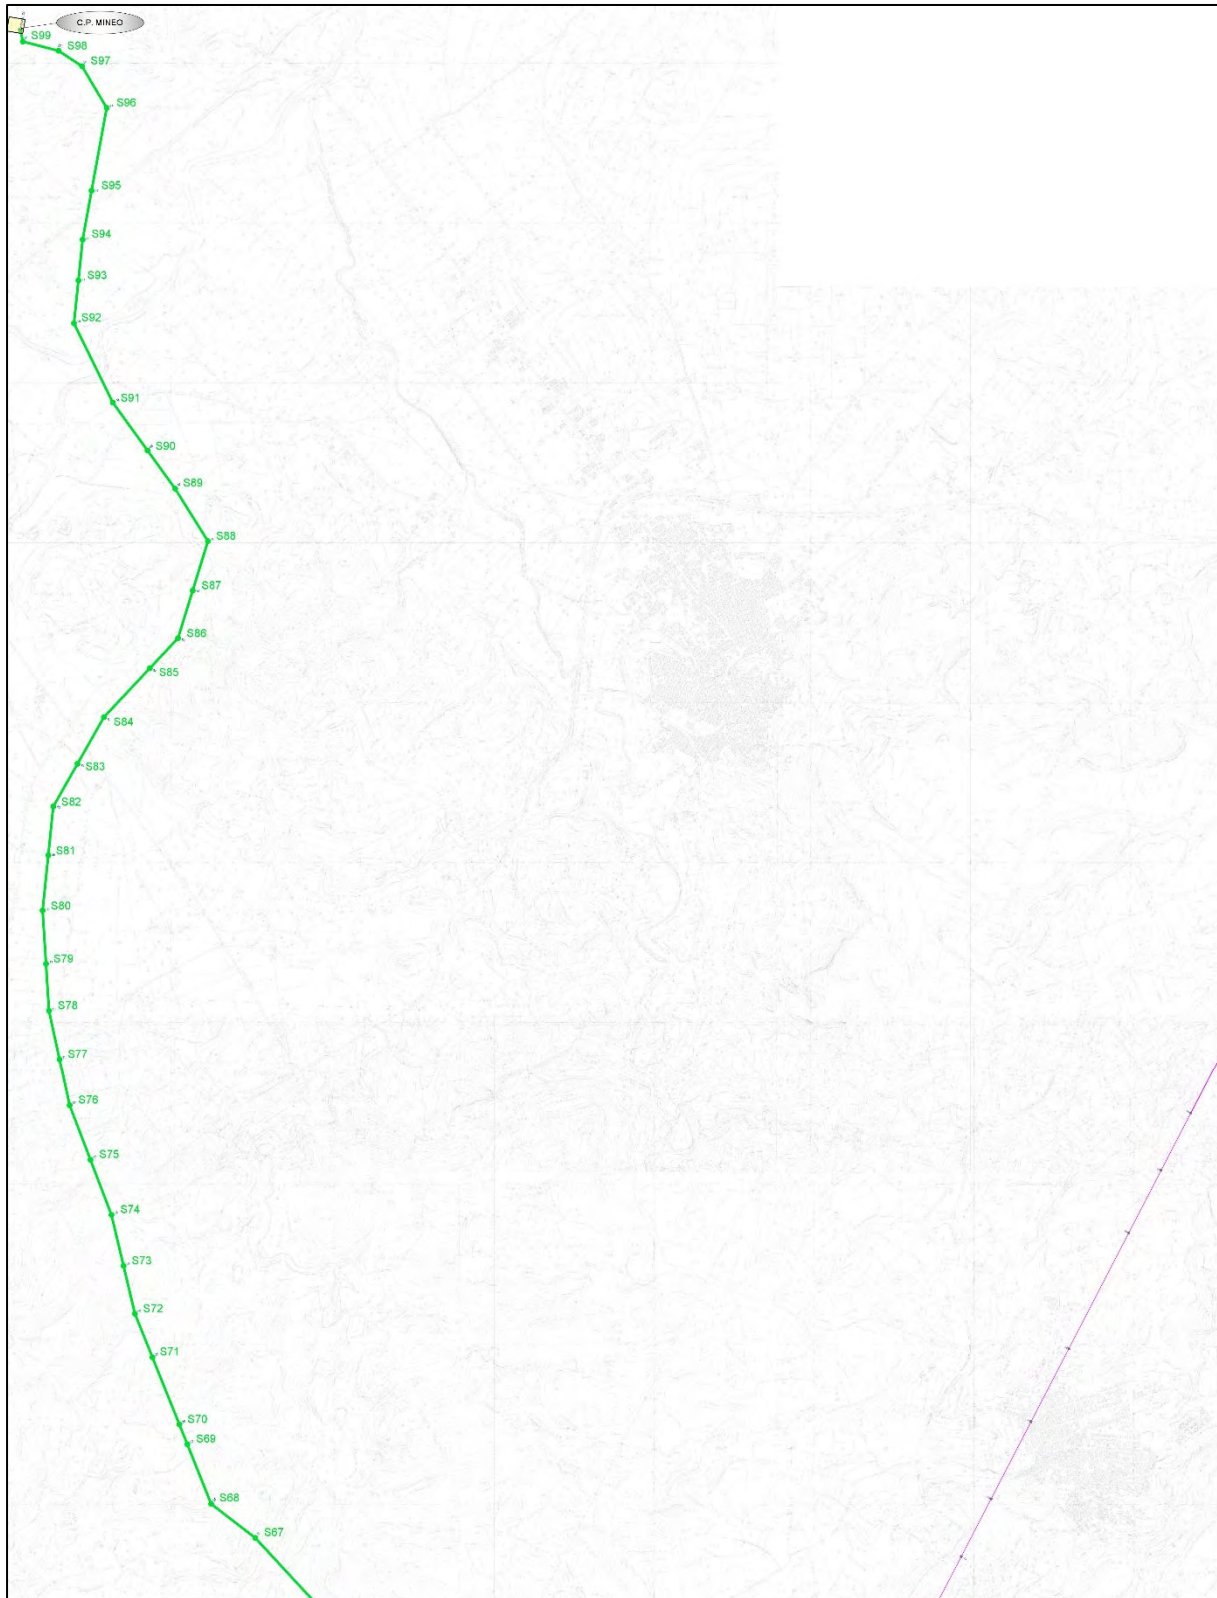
Planimetria con ubicazione prelievi linee foglio 03\_1
